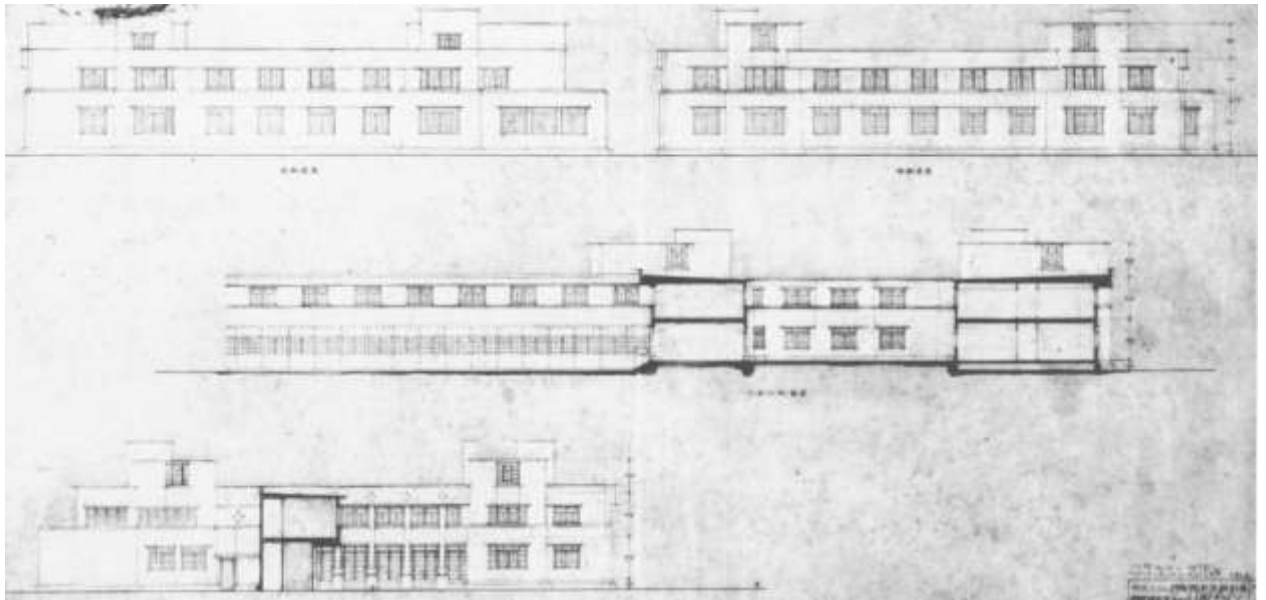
Elevaciones generales Hotel Imperial. . Planta primer nivel Hotel Imperial. Planta del conjunto. Frank Lloyd Wright Arquitecto. En: Kathryn Smith, Frank Lloyd Wright and the Imperial Hotel: A Postscript. Fuente: Frank Lloyd Wright Foundation, 1982.
